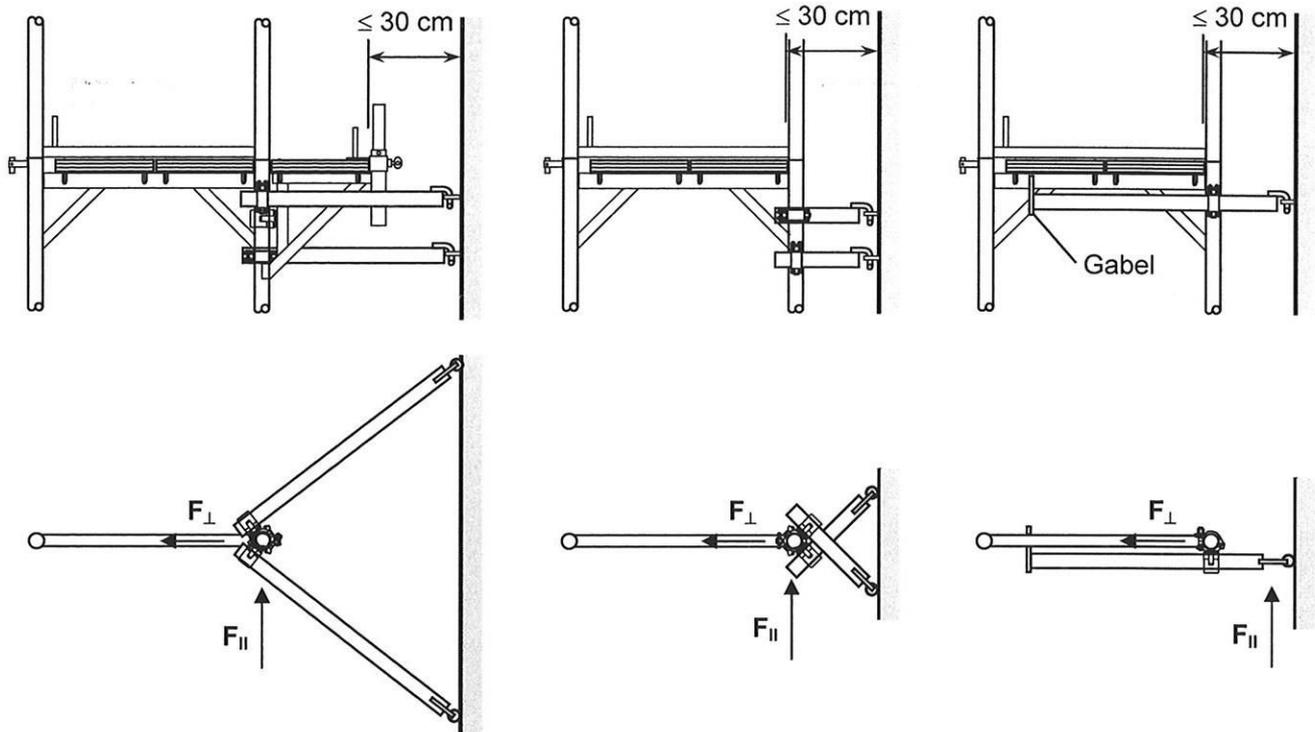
Höhenlage der Gerüsthalter bei Anschluss im „Knoten“
